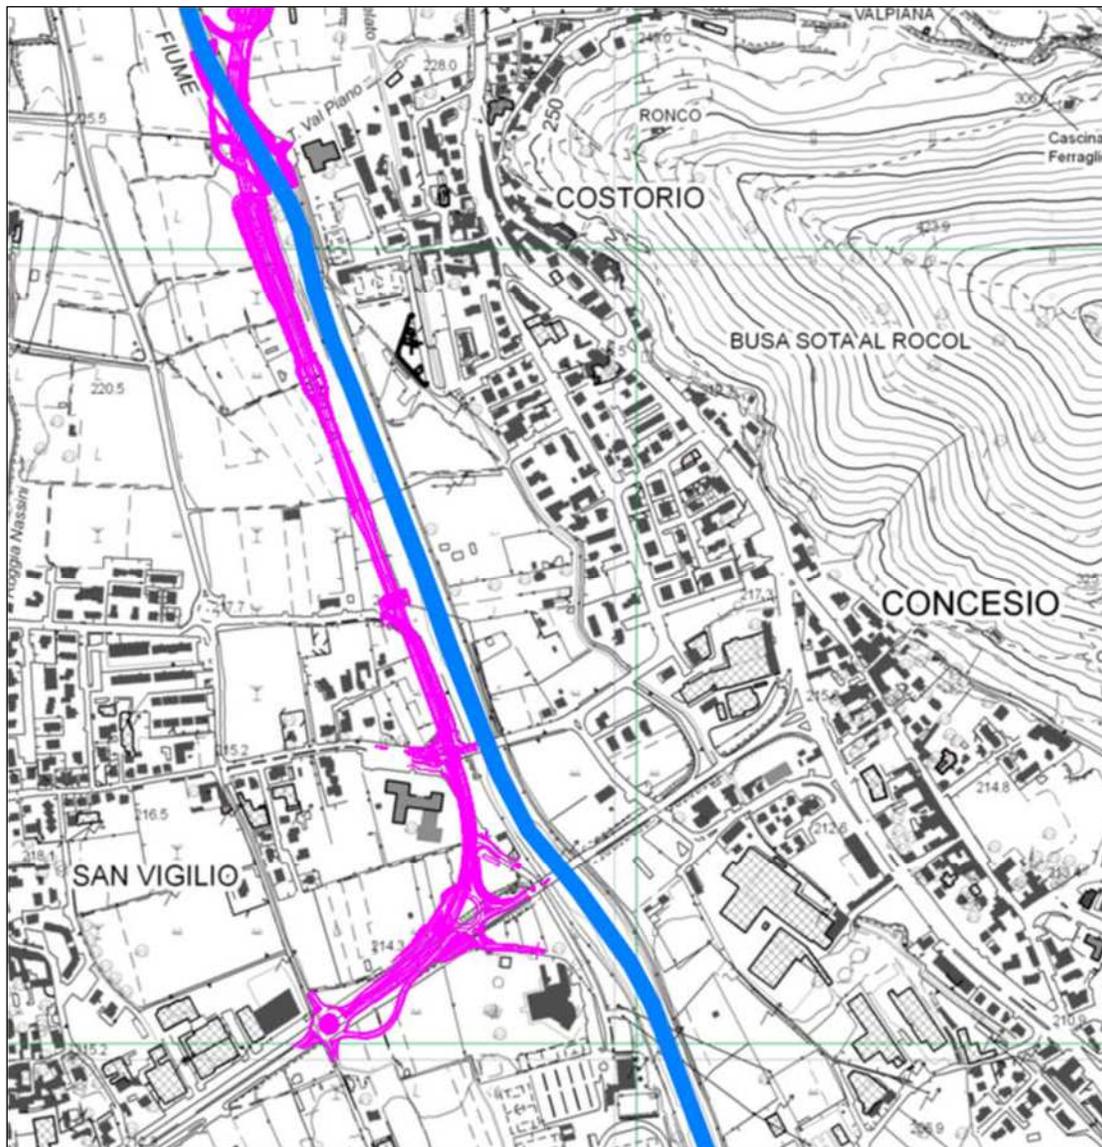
Opere in progetto. Rilevato San Vigilio
